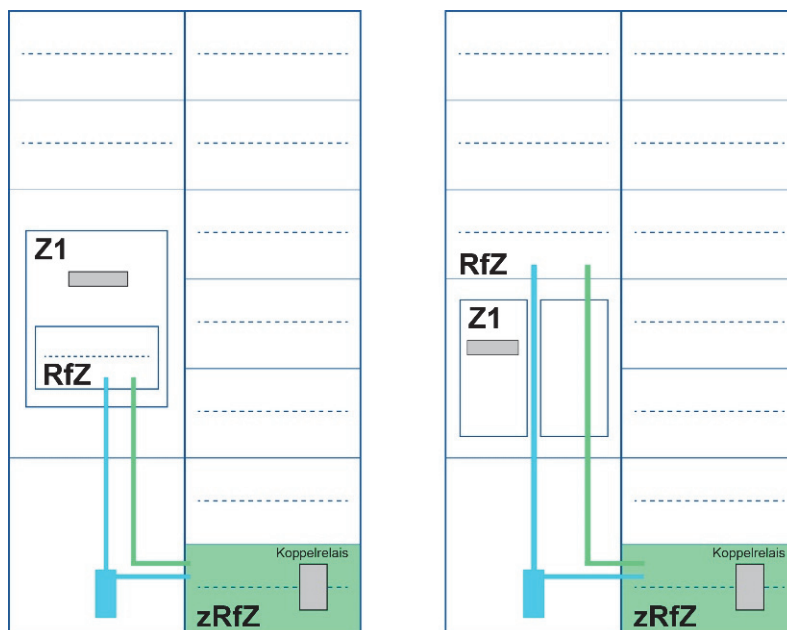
Bestandszählerplatz mit einem 1-feldrigen Zählerfeld
